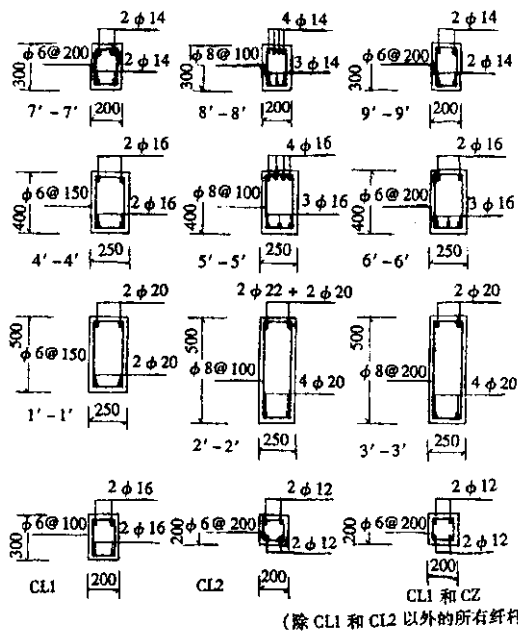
钢筋砼桁架杆件和构造柱的断面和配筋
